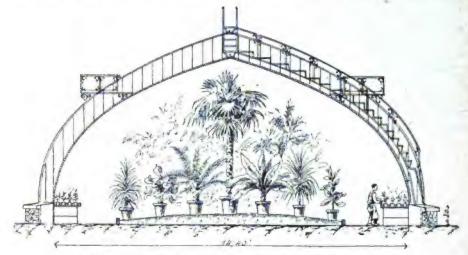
Coupe transversale d'une des ailes de la grande serre.
